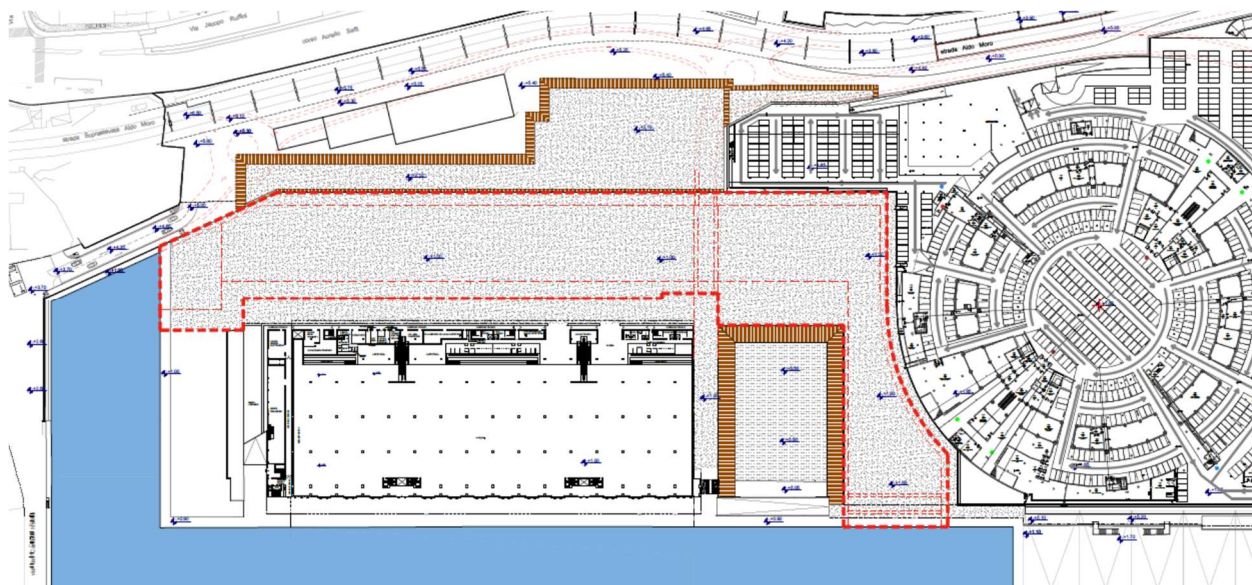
Stato di fatto dell'area ad avvio interventi di realizzazione canali. Stralcio elaborato di progetto Ar-T02
